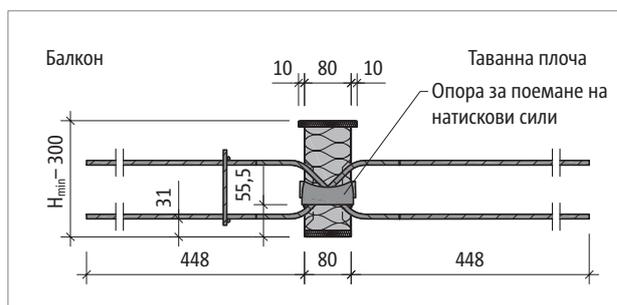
Schöck Isokorb® T mun QL-V4: Сечение на продукта
